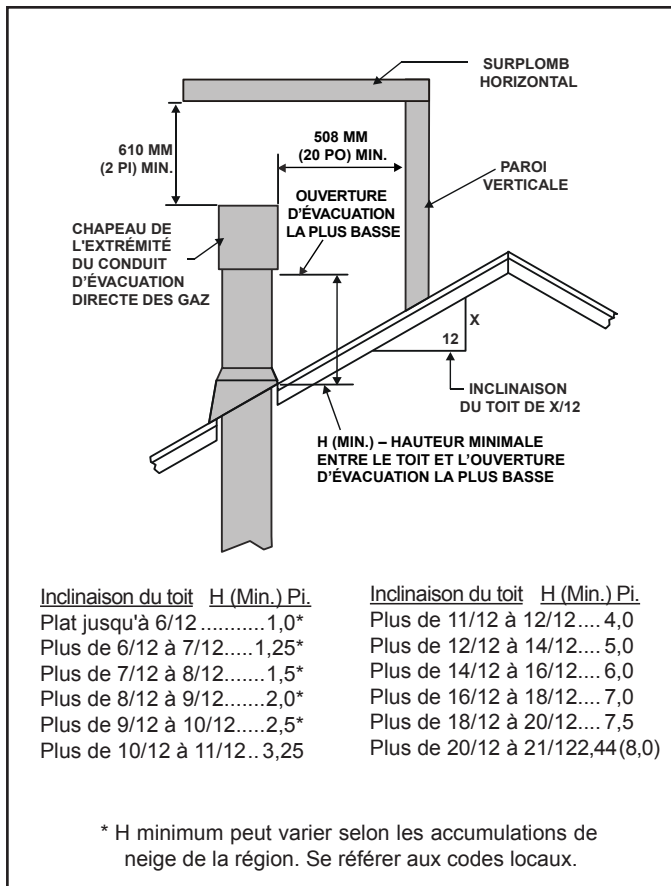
Hauteur minimale entre le toit et l'ouverture d'évacuation la plus basse
